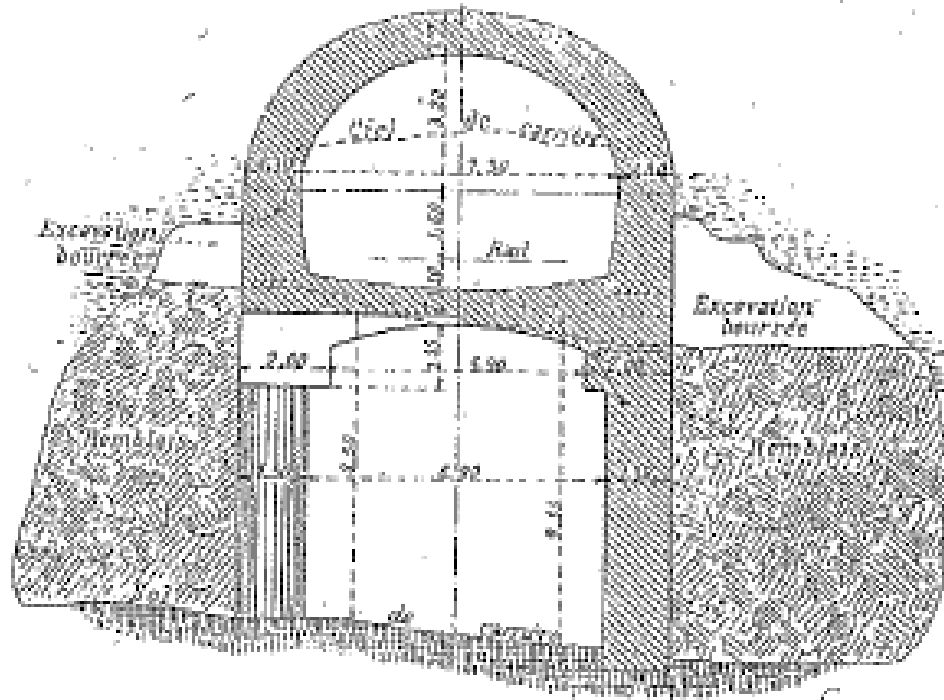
Section de tunnel maçonné, traversée de carrières (Biette, 1928)
